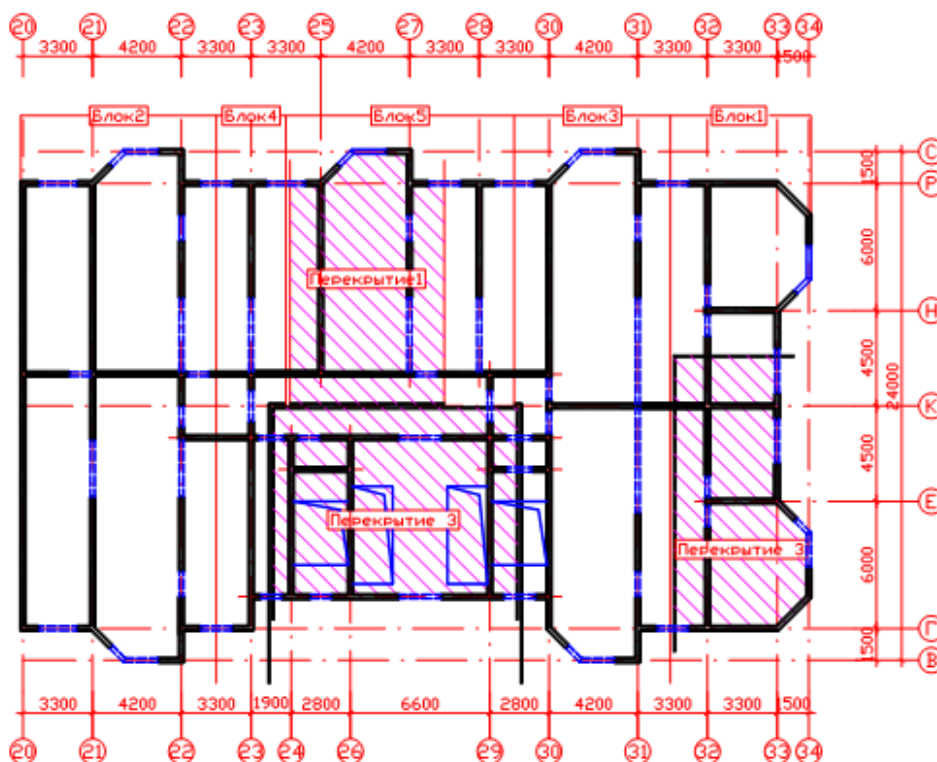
Поблочное расположение расчетных элементов конструкции перекрытий
